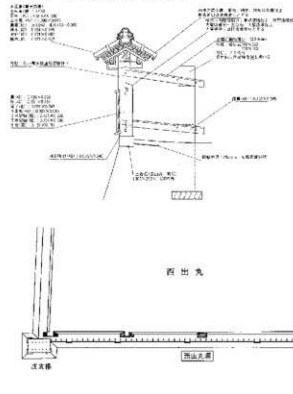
奉行丸・西出丸の土堀配置図と断面図
